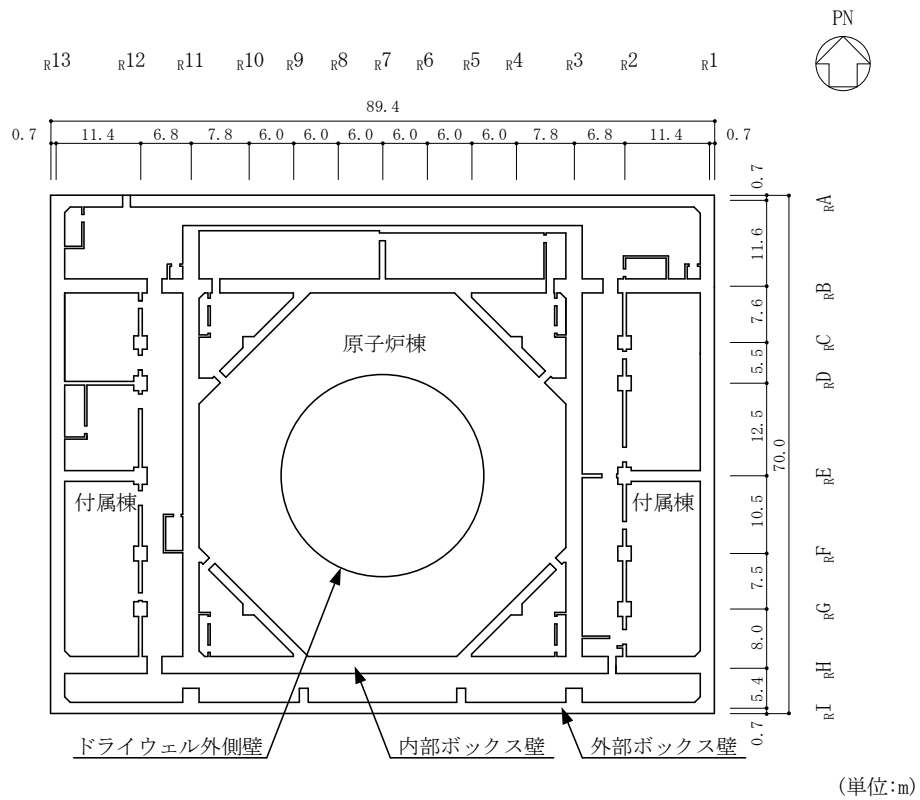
原子炉建物基礎スラブの概略平面図 (EL 1.3m*)
